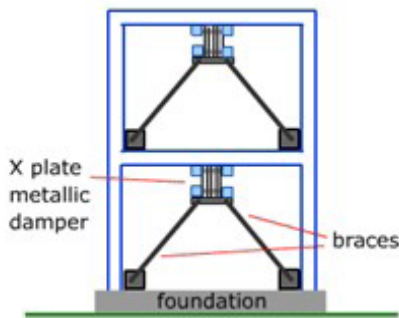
Ilustração da aplicação dos *Metallic Dampers*, tipo “X” em uma estrutura.
